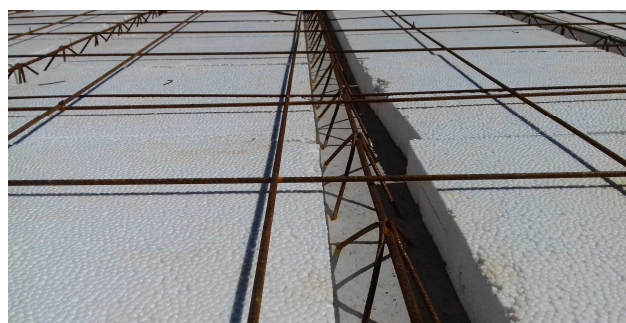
Detalhe de lajota de EPS, vigota treliçada e armadura de distribuição
